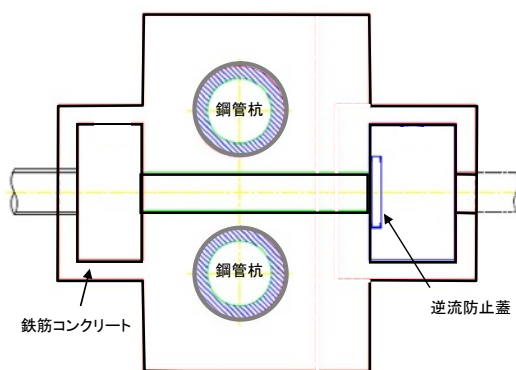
屋外排水路逆流防止設備平面図 (例)
